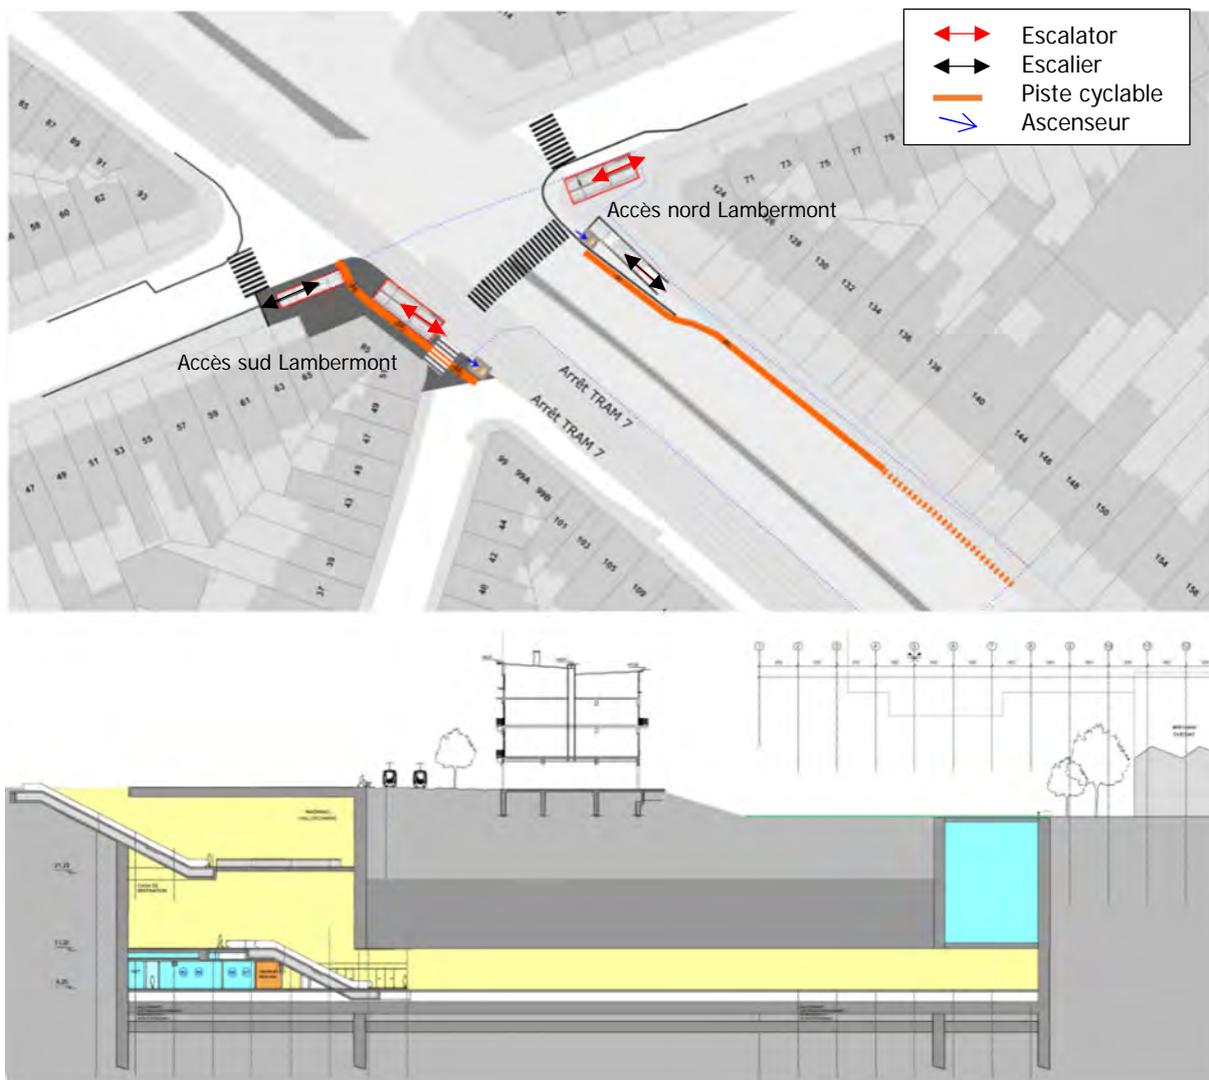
Plan du niveau 0 (en haut) et coupe longitudinale (en bas) de l'alternative de localisation (ARIES, 2020)
